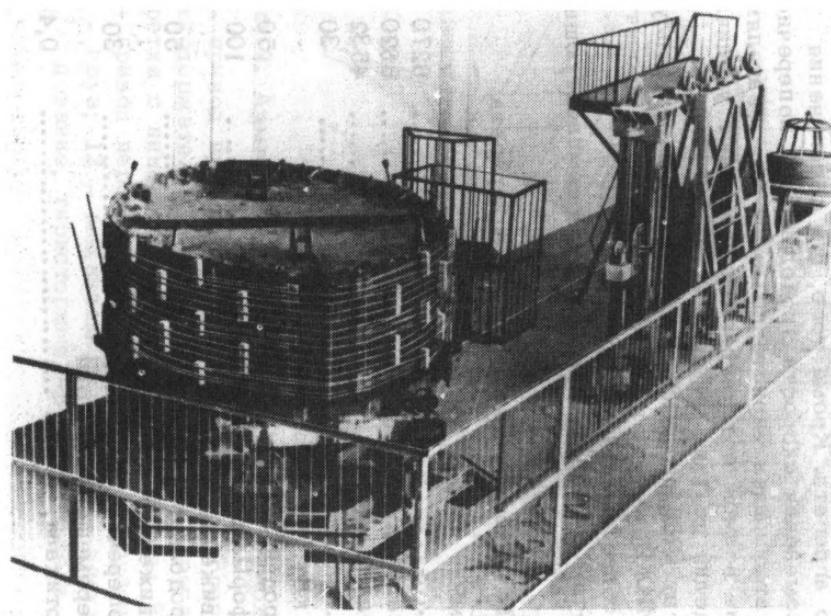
Общий вид арматурно-намоточного агрегата с поворотной платформой
